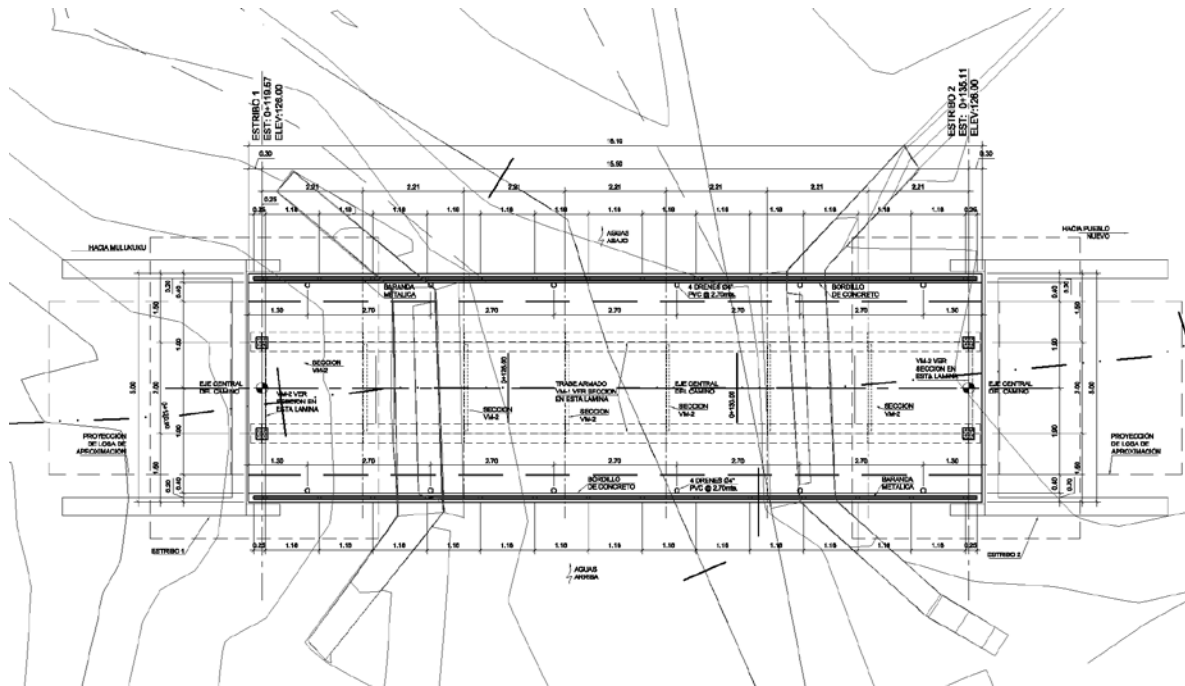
Planta de emplazamiento del Puente Santa Rosa
